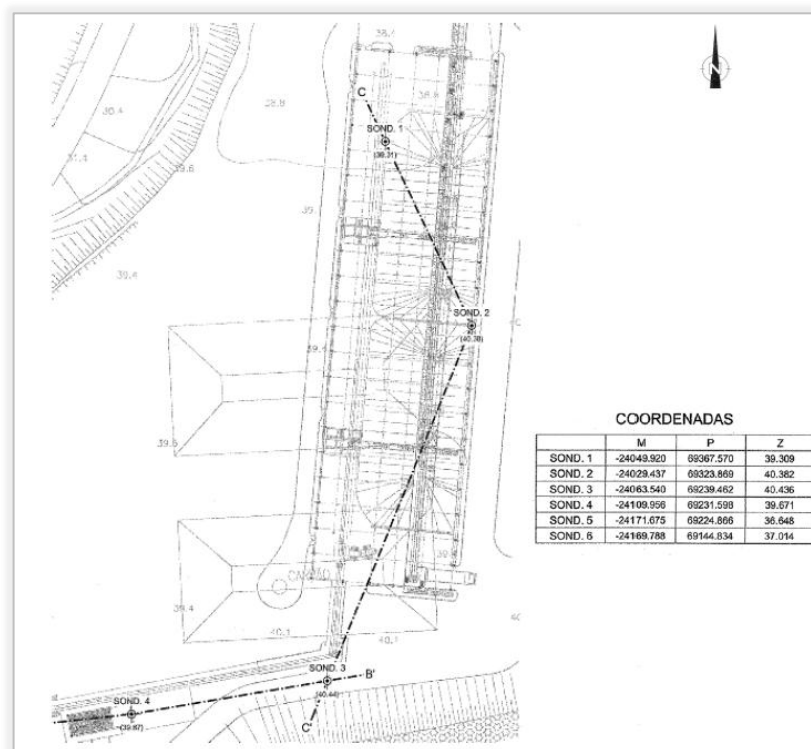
Reconhecimento geotécnico - Planta de localização.
